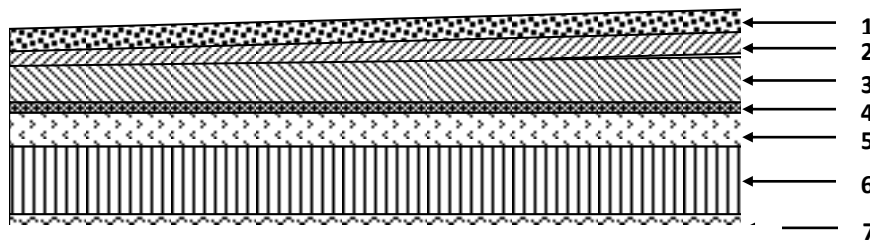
Coupe du plancher de la terrasse inaccessible
